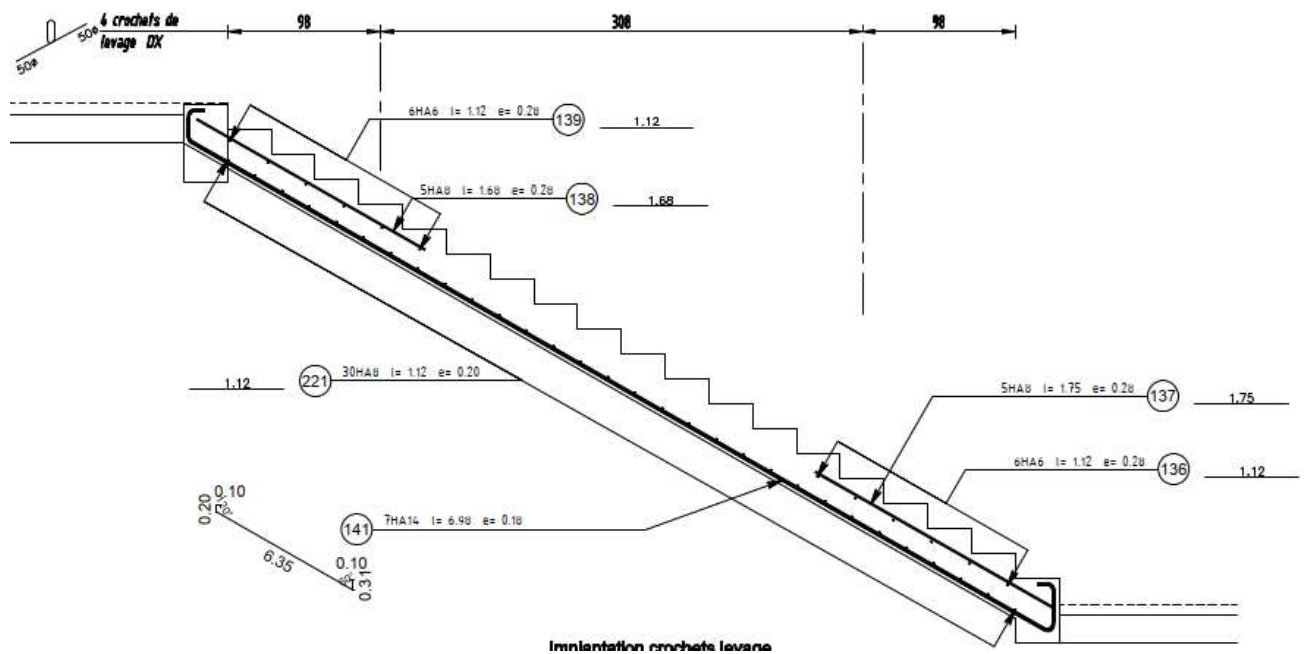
Ferrailage de l'escalier du R+1 (vue en coupe)
